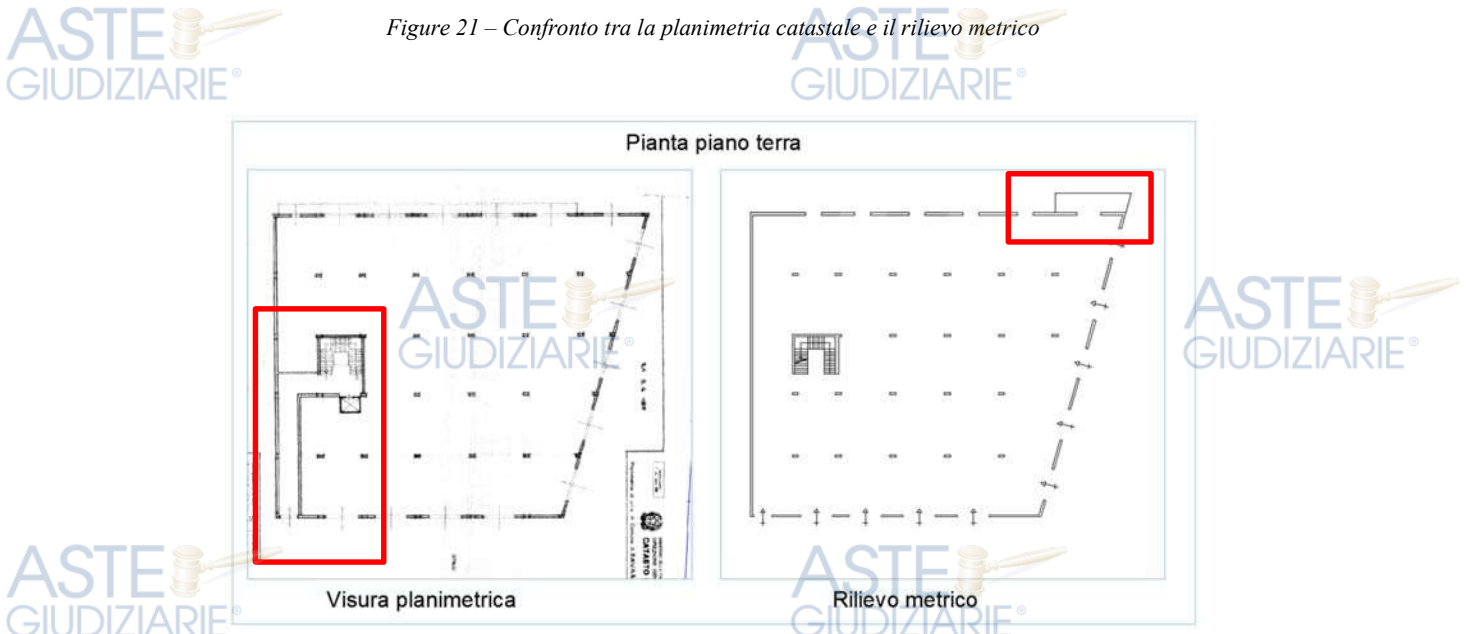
confronto tra la planimetria Catastale e la planimetria dello stato reale dei luoghi; in rosso le difformità riscontrate
